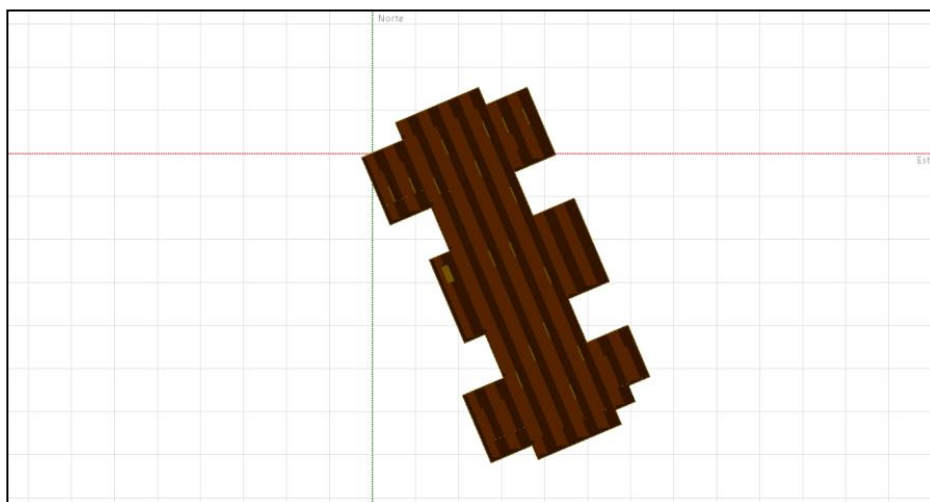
Plano modelado cubiertas edificio [Elaboración propia]
